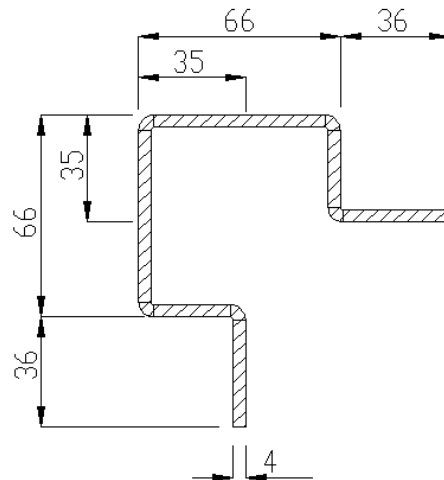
Secção transversal do perfil utilizado pela GRUPNOR[®]
